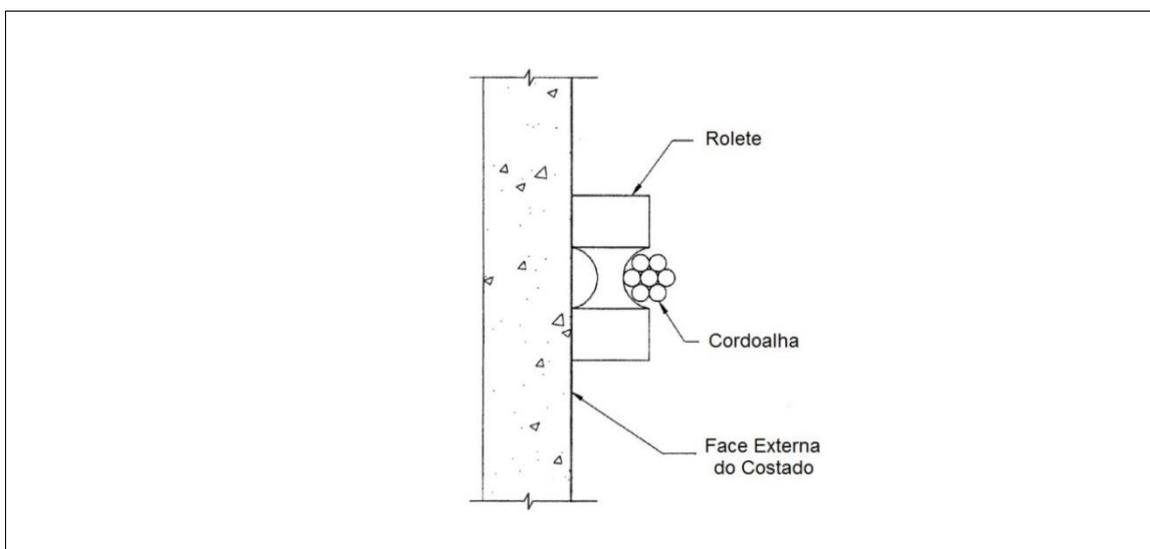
Detalhe dos roletes utilizados para protensão externa circular [adaptado de ACI 373 R (2010)].
